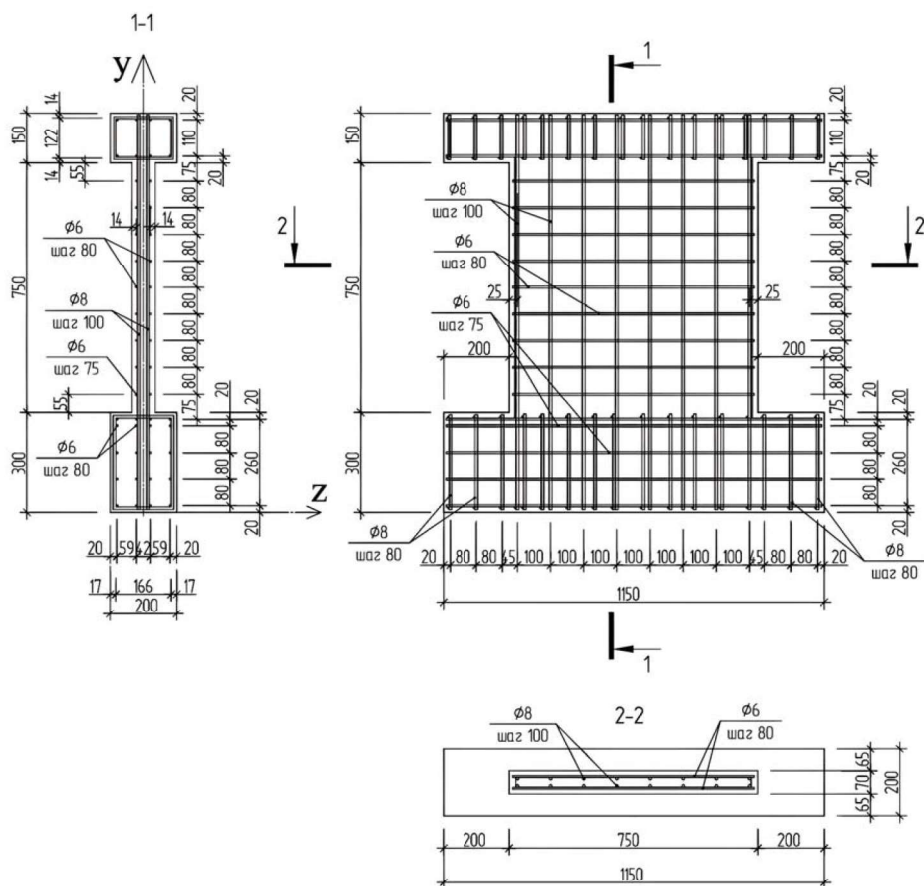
Армирование железобетонной стены в эксперименте и компьютерной модели в BK Ansys
